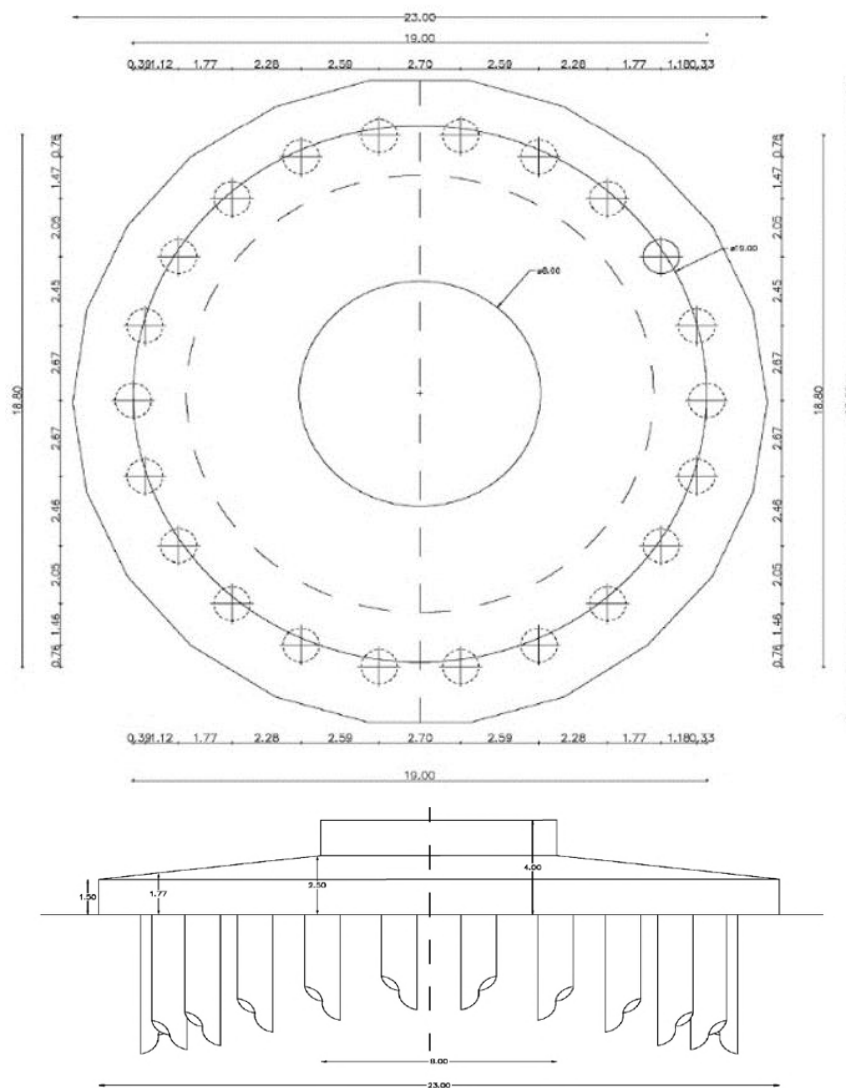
Pianta e prospetto della fondazione dell'aerogeneratore
